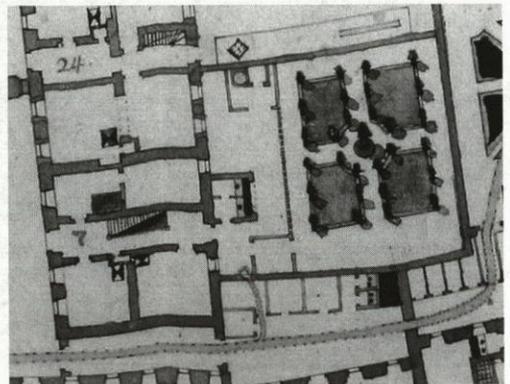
Obermünsterplatz 11, Grundriss vor 1766
